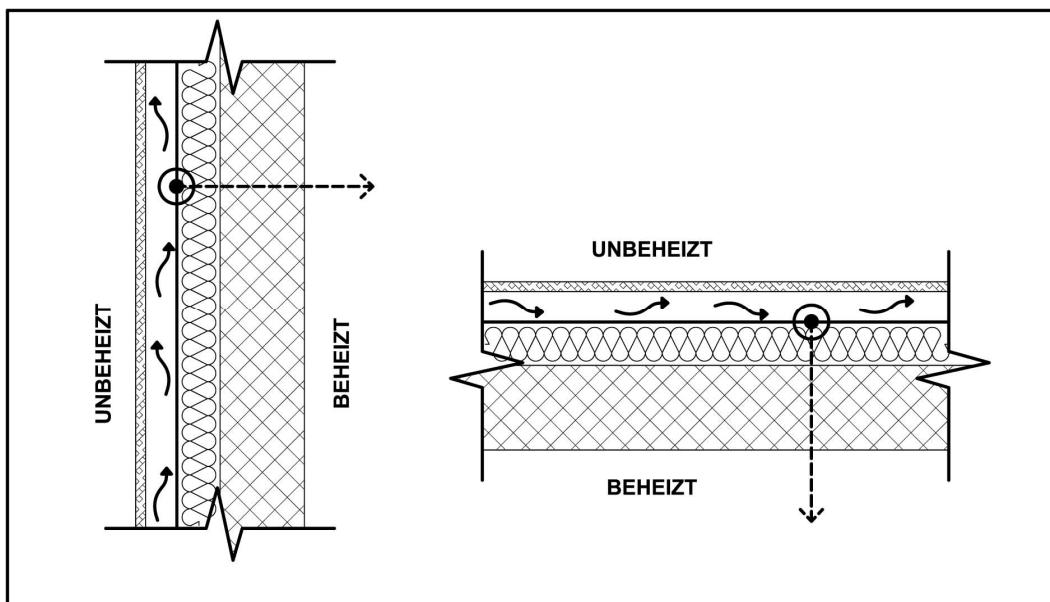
der Punkt zeigt die Grenze der beheizten Gebäudehülle einer belüfteten Wand, Dach oder Decke
